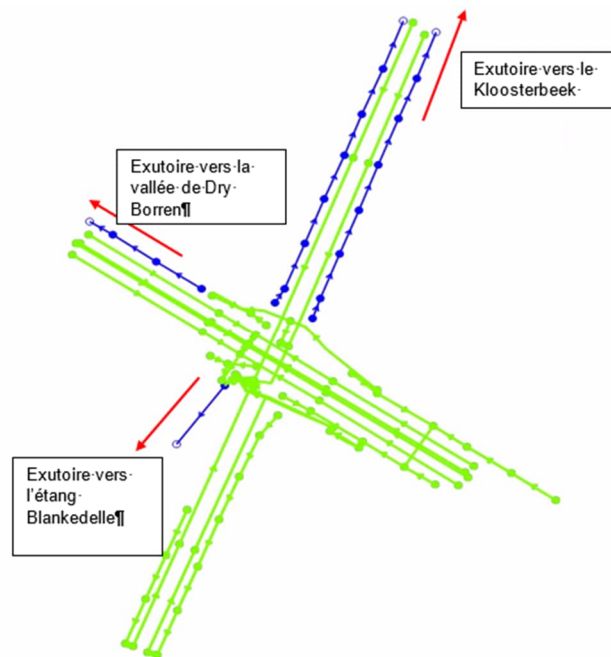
Système d'égouttage existant : les conduites connectées à la station (vert) et celles raccordées aux réseaux d'égouts existants (bleu).
